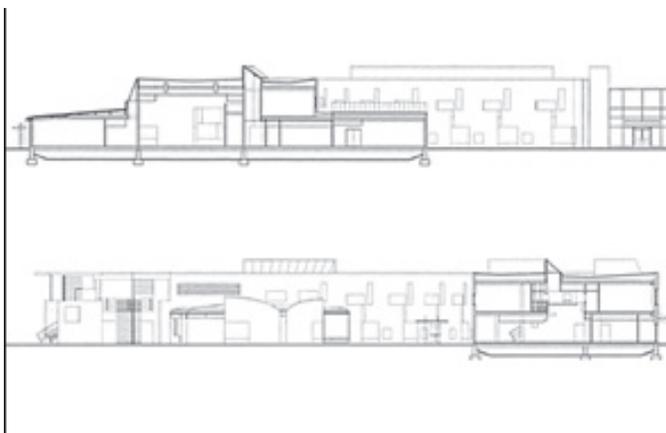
, 372: planimetria e sezioni. (Fonte: [www.projektarna.si](http://www.projektarna.si))
